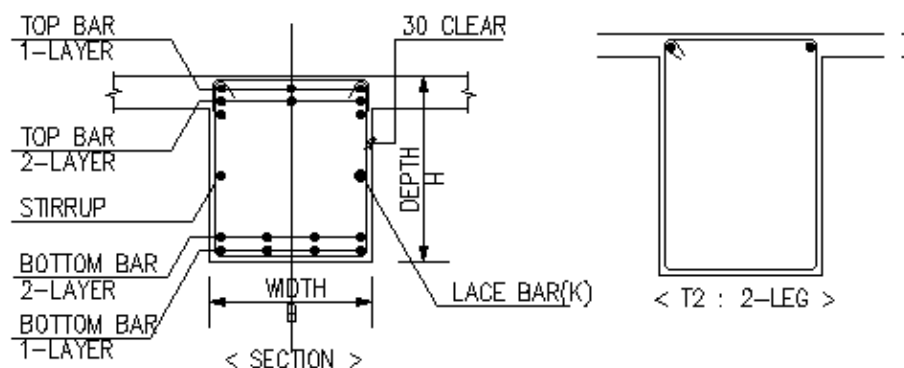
Coupe sur la poutre de la dalle nervurée
